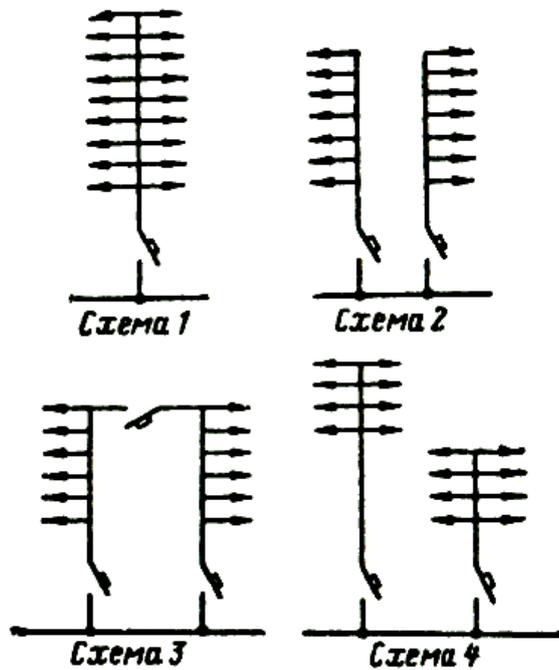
Принципиальные схемы стояков, рекомендуемые по экономическим соображениям
